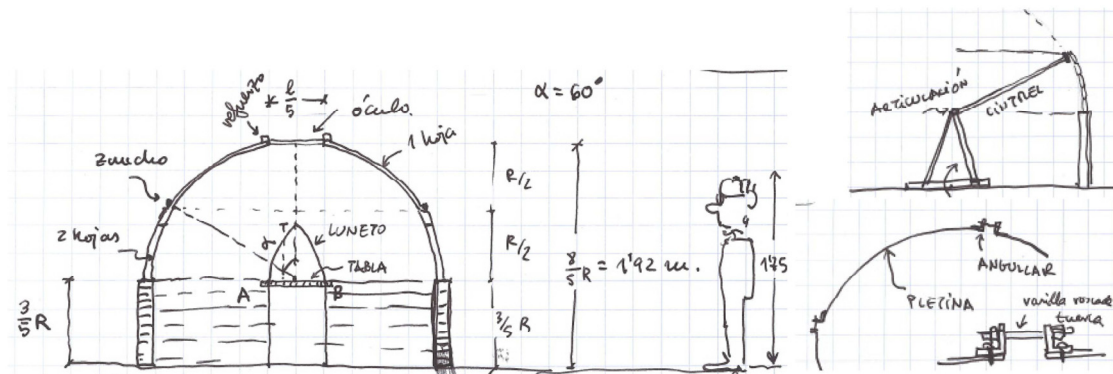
Proyecto de pequeño panteón. A la izquierda, sección; a la derecha, detalles del proceso constructivo y del zuncho metálico.
